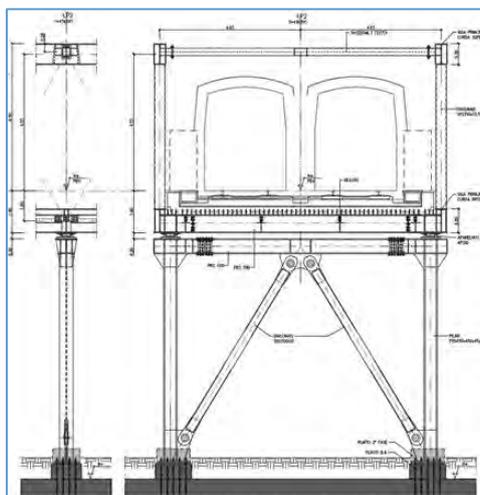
Secção transversal e longitudinal P2, P3 e P4
